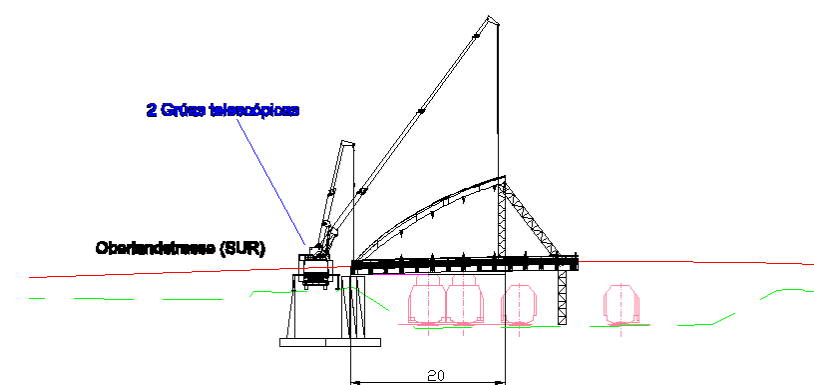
Figura V: COLOCACIÓN DEL SEGMENTO DE ARCO SUR Y APOYO SOBRE APEO PROVISIONAL
